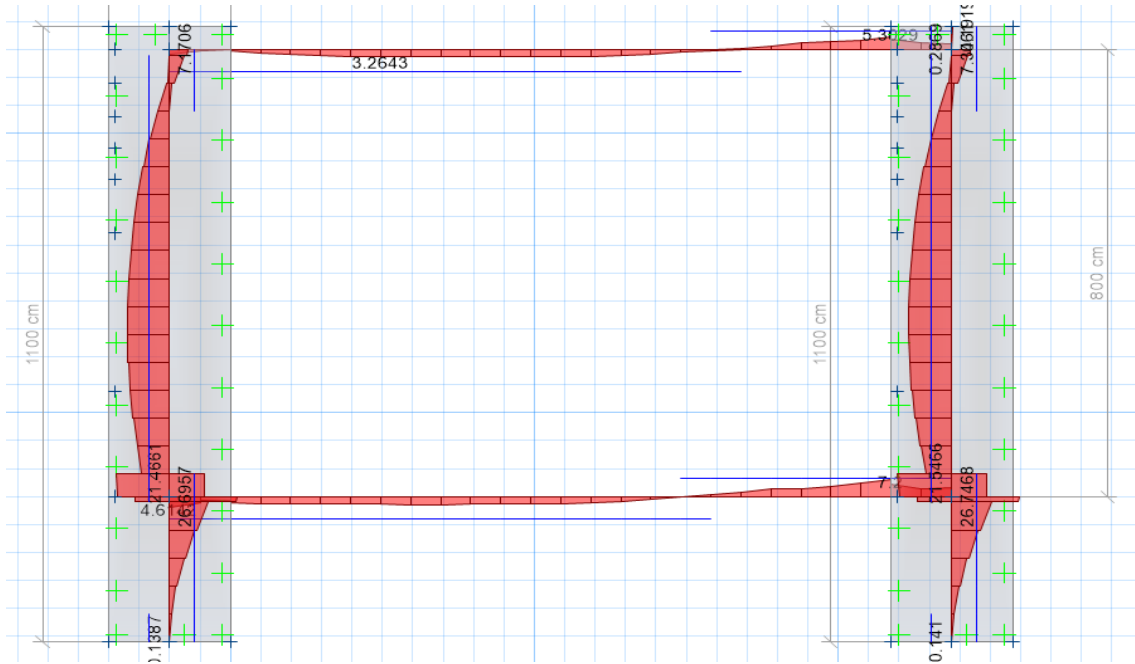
Diagrama de Aceros de refuerzo en vigas requeridos para la cimentación de carga en caliente
